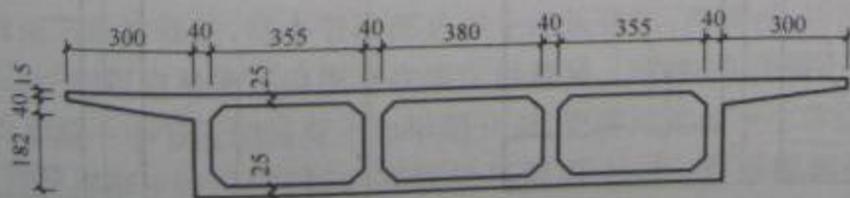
某桥横截面尺寸 (尺寸单位: cm)
